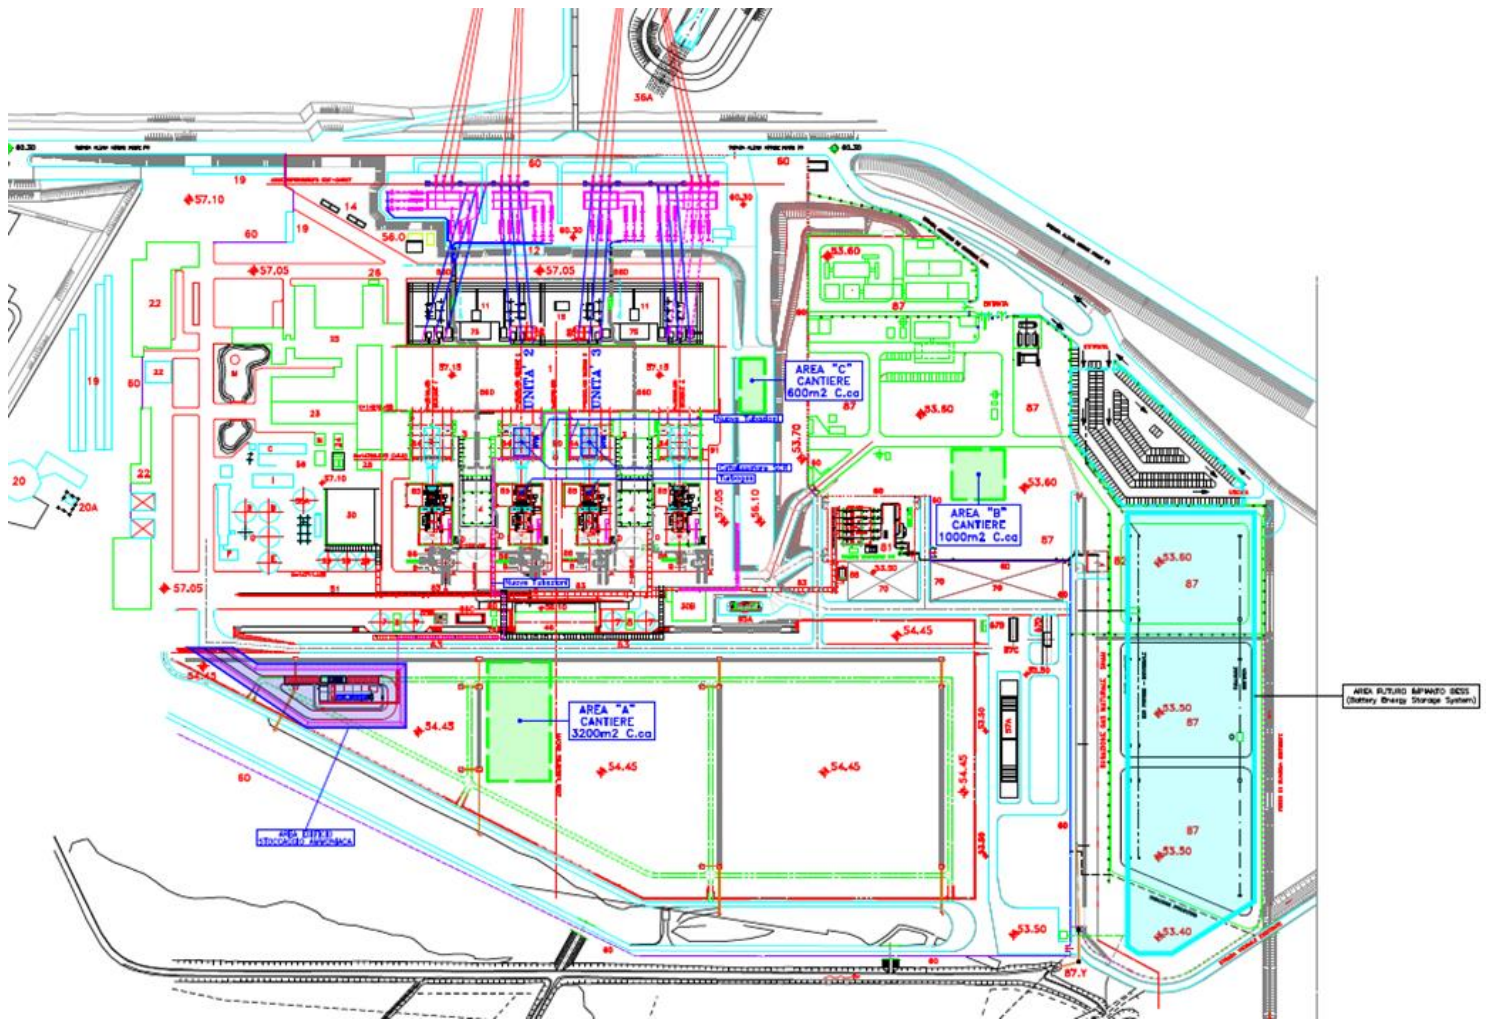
Planimetria generale di impianto – Nuove installazioni (etichetta blu) (Fonte: Allegato 1 della Relazione di Progetto)
